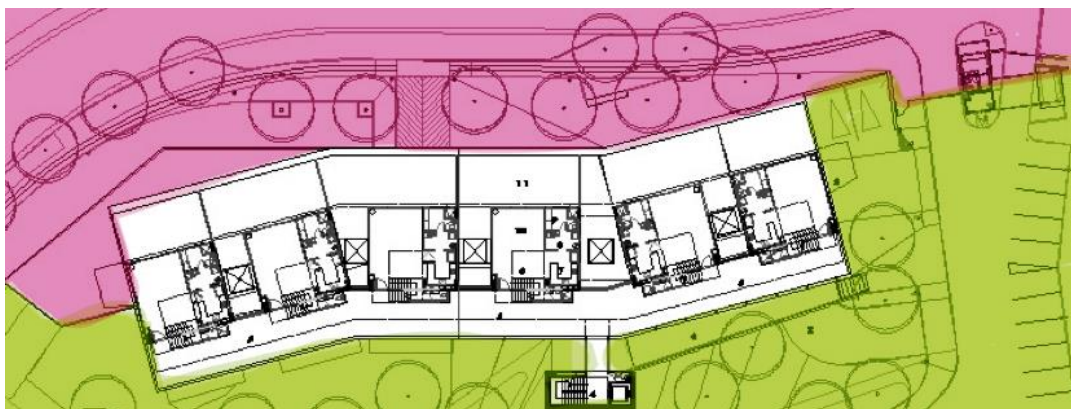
Interior (verde) y exterior (magenta) del proyecto.
